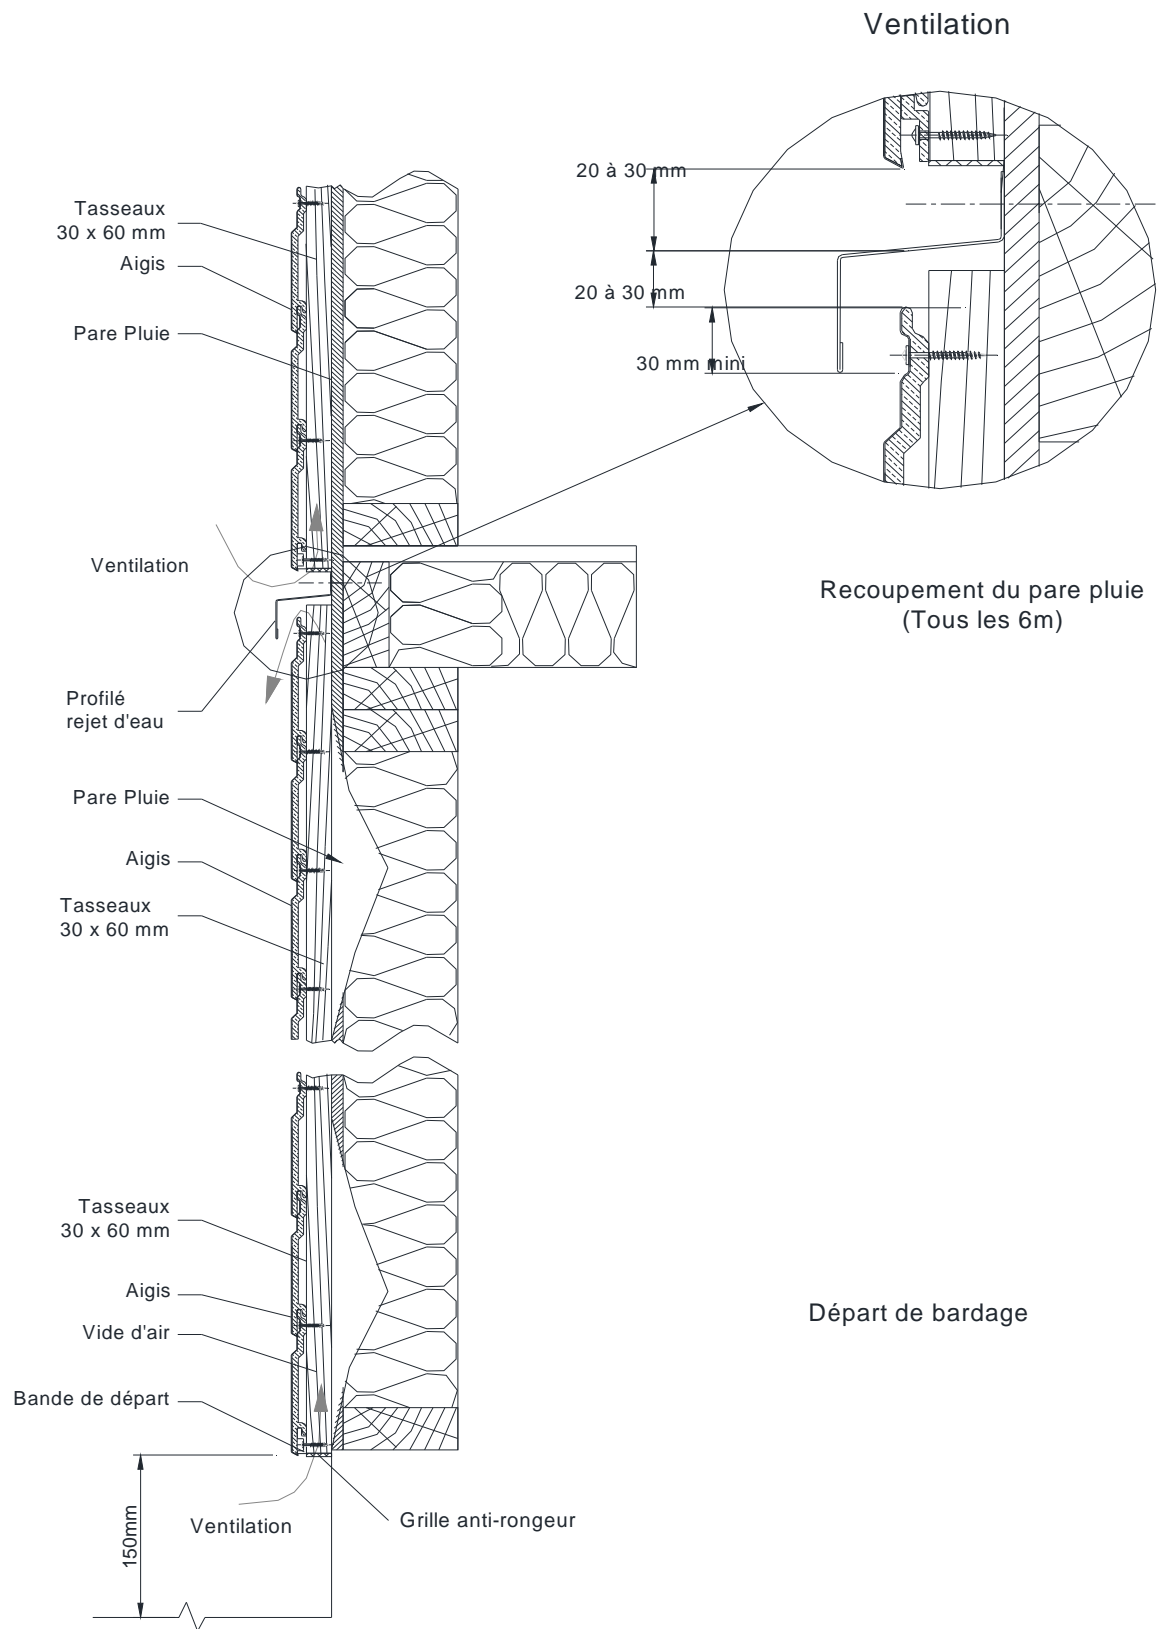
Coupe verticale sur COB et recoupement du pare-pluie
